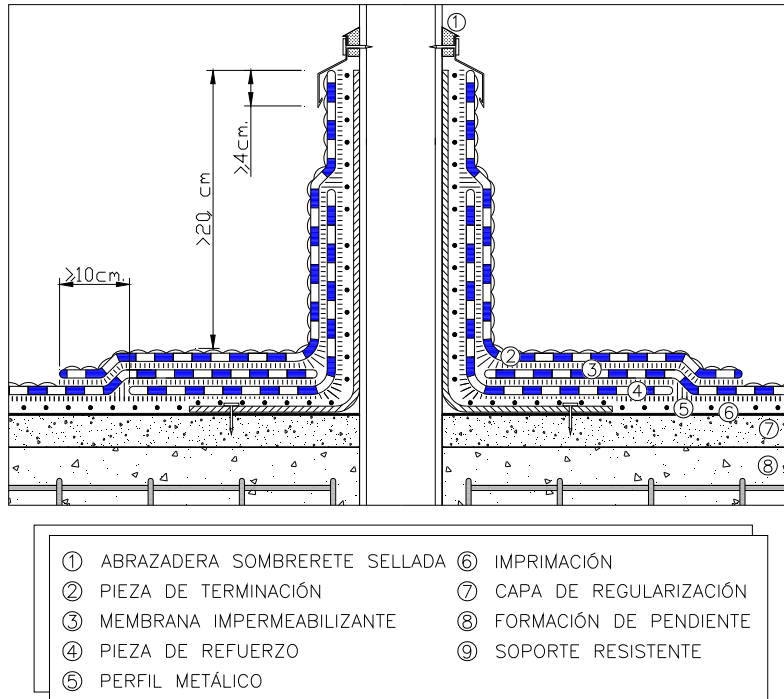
ejemplo de encuentro de un faldón con un elemento pasante solucionado con manguito rígido
